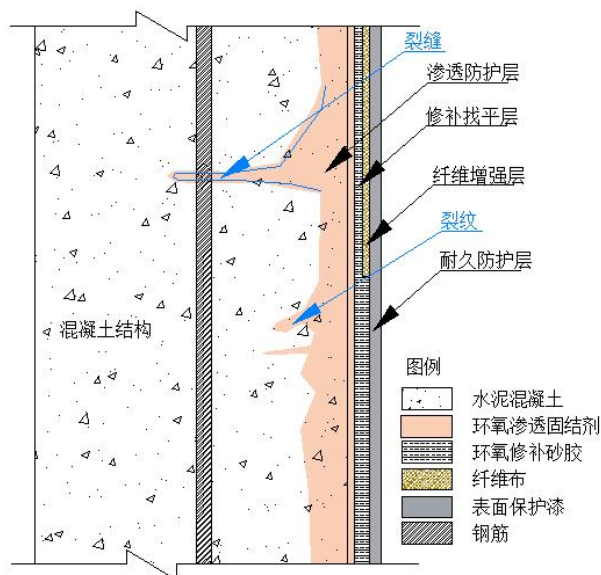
c 混凝土表面病害待维修构件防护体系构造
